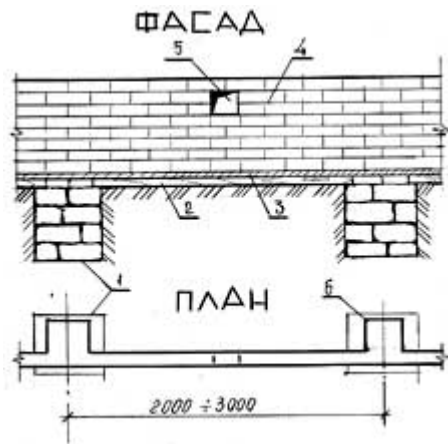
Фрагмент столбчатого фундамента с забиркой из монолитного железобетона:
